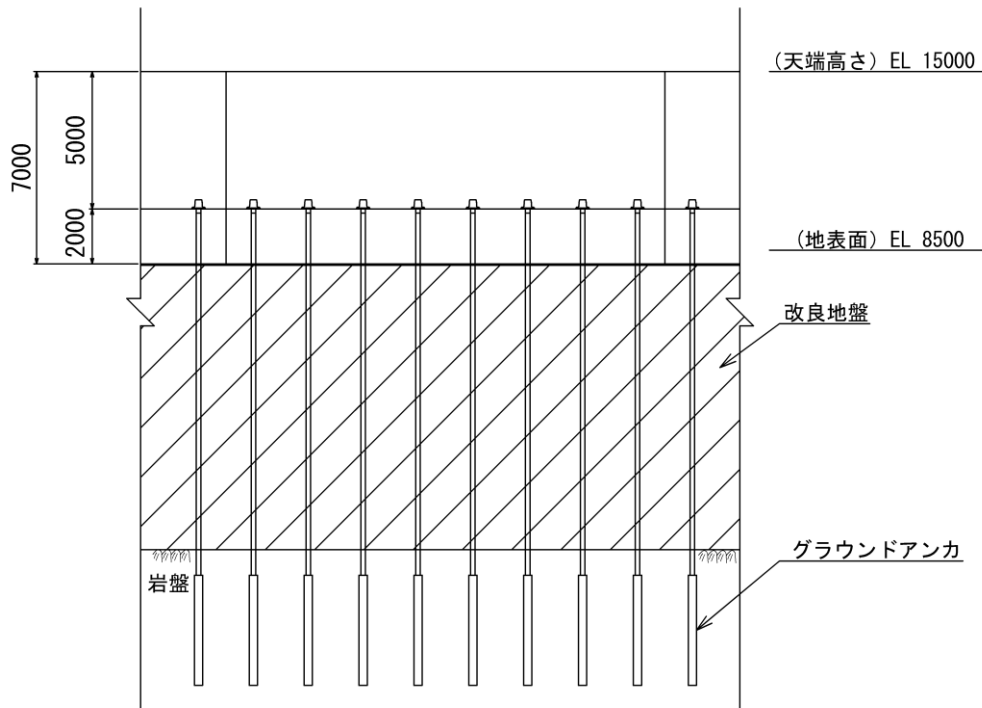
(1) 防波壁 (逆 T 擁壁) の構造図 (正面図)
